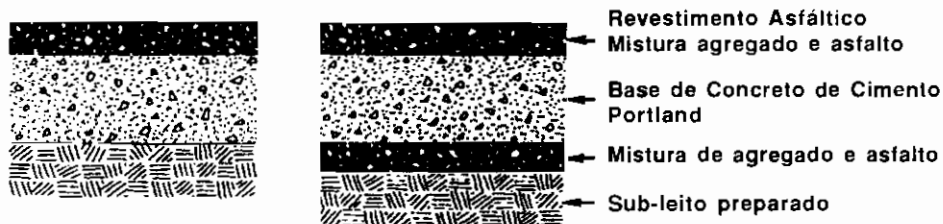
Seções Transversais de Pavimentos Mostrando Estruturas Típicas de Pavimentos Asfálticos.
